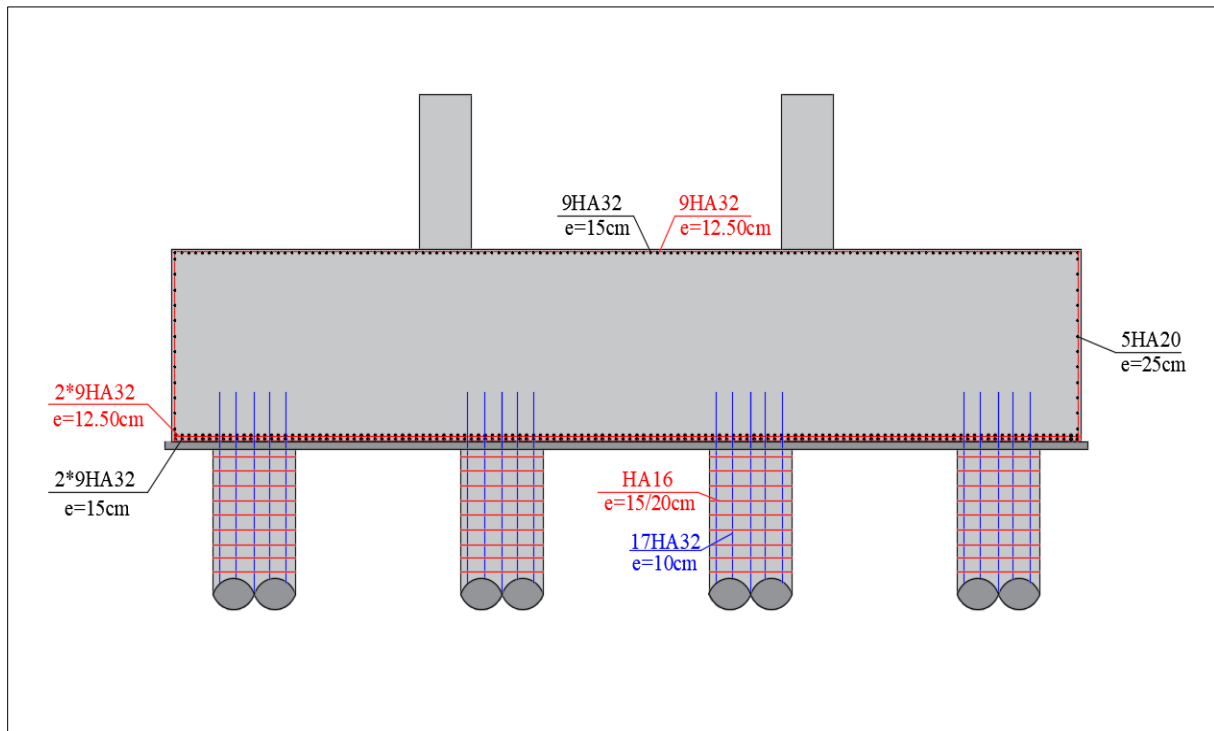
Ferrailage de la semelle de la pile.
